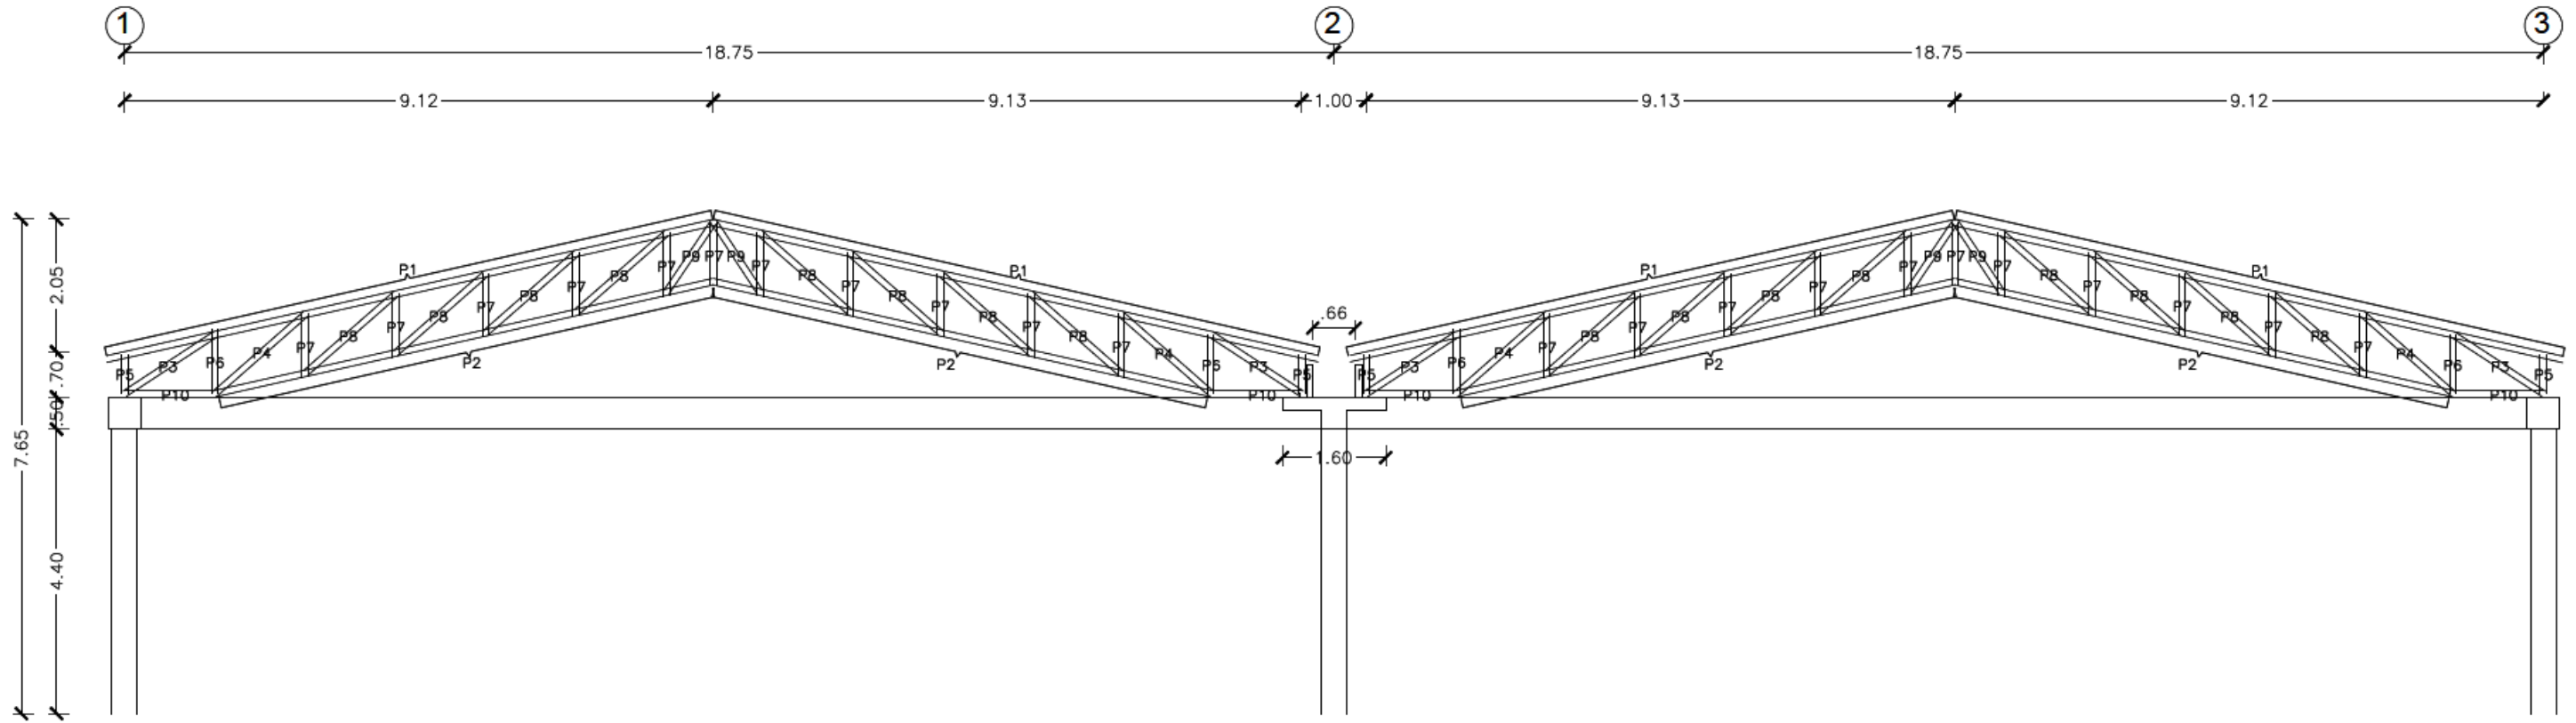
Vista frontal de la cubierta metálica del mercado de Guaylabamba—Ejes B' a J
